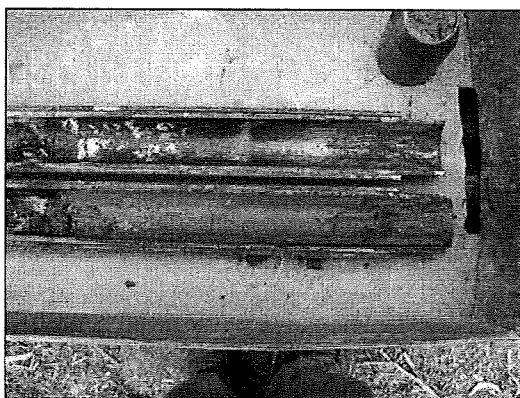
Sondeig S-3. SPT a 10,4 metres.
